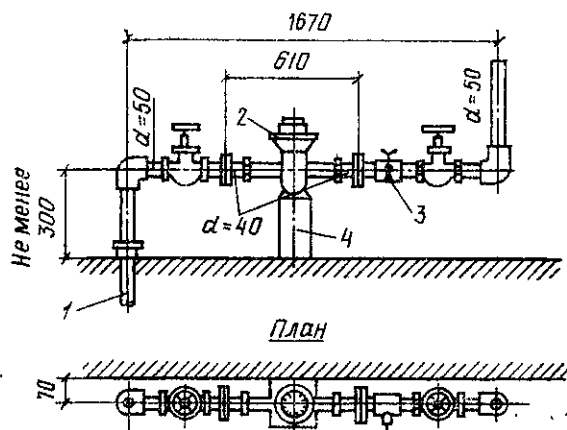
Присоединение крыльчатого водомера к трубопроводу на фланцах
